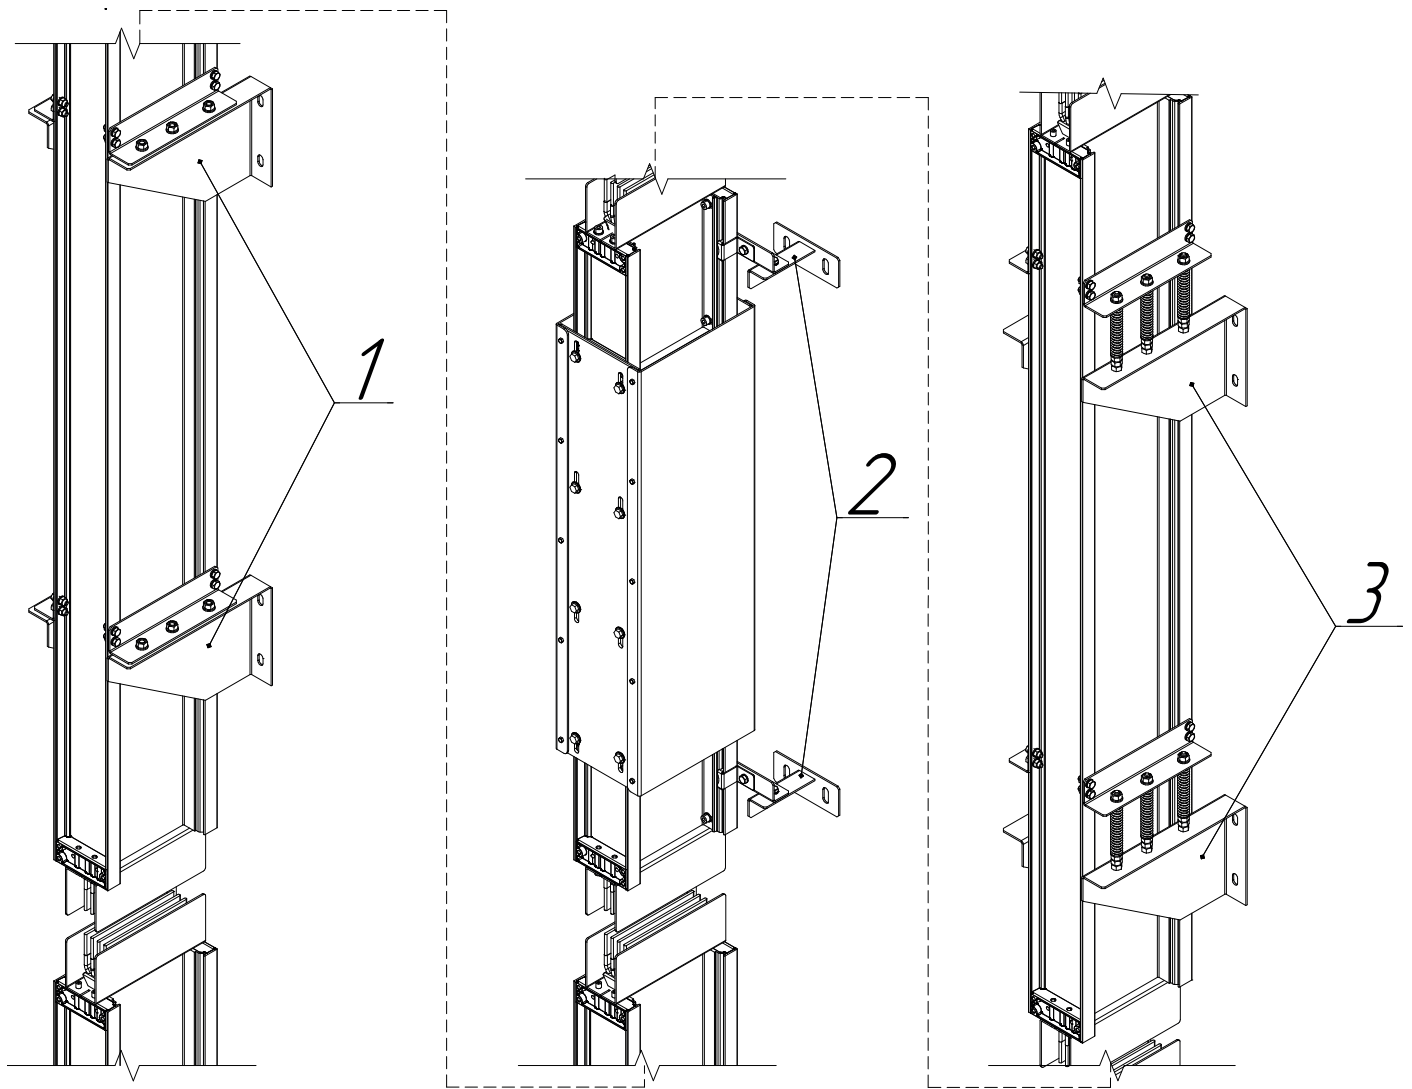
Схема вертикального крепления шинопровода к стене: 1 – жесткое крепление к стене; 2 – универсальное крепление к стене; 3 – пружинное крепление к стене.
